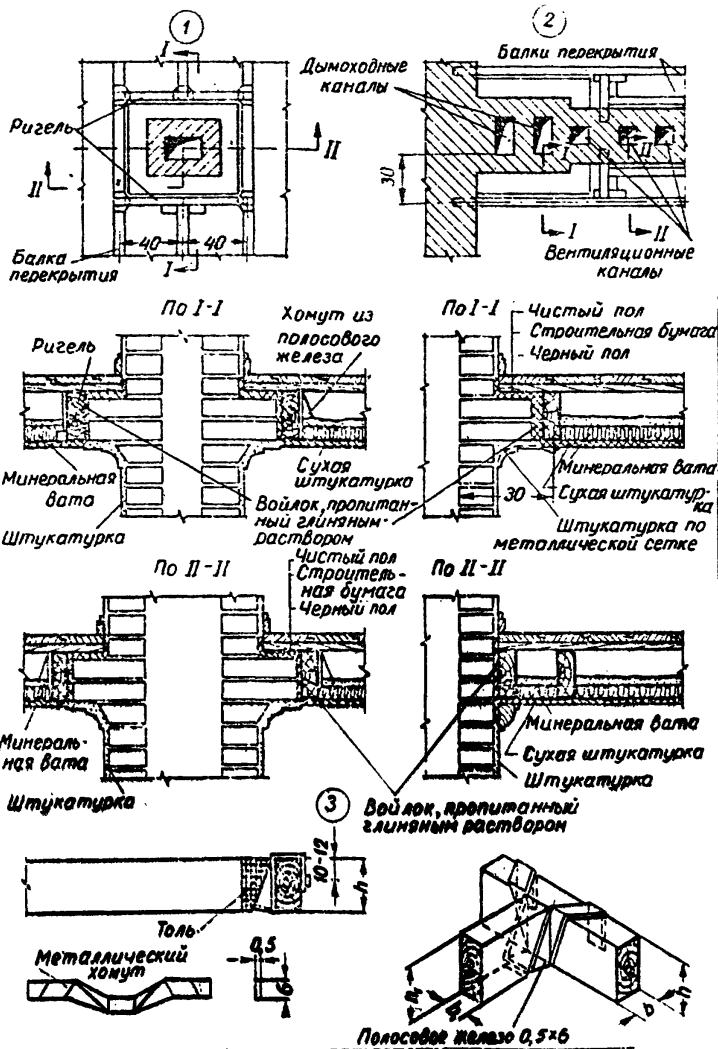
Примыкание перекрытий к трубам и дымоходным каналам
